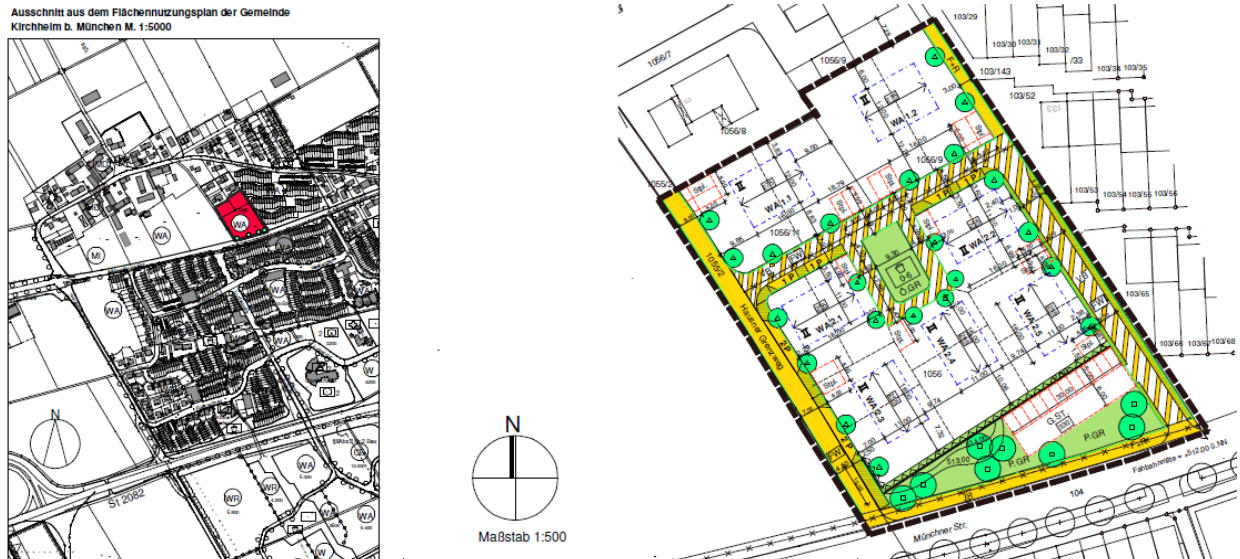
Bebauungsplan Nr. 90 - 1/K Fassung 07.02.2011 (Quelle: www.kirchheim-heimstetten.de)
